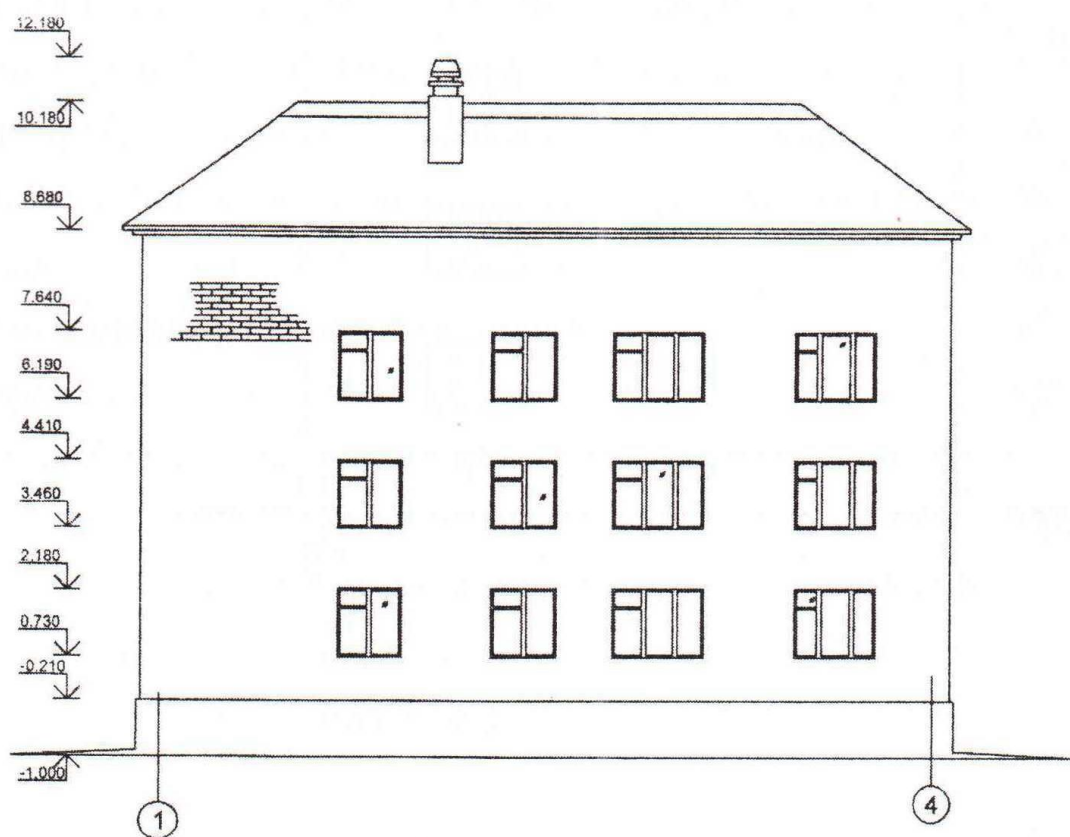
Фасад будівлі (головний) М 1:100
